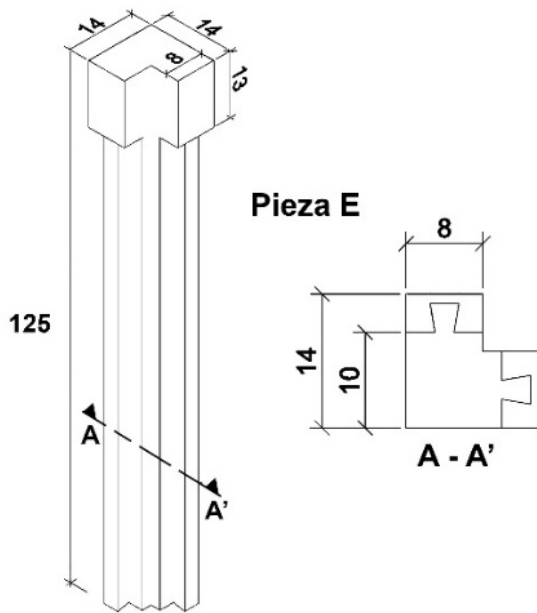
Vista en perspectiva y corte transversal del diseño de la pieza E (cotas en cm).
